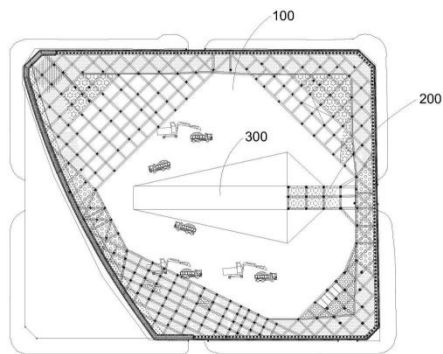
提供的钢混栈桥与土方坡道无缝衔接的施工现场的施工示意图
